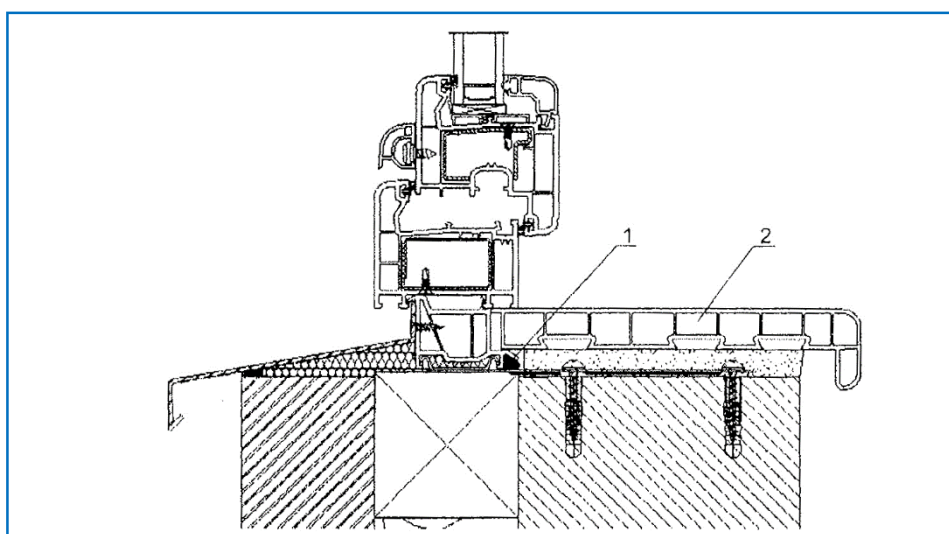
przedstawiono sposób dodatkowego zamocowania parapetu poprzez zastosowany kątownik przykręcony do listwy parapetowej.
